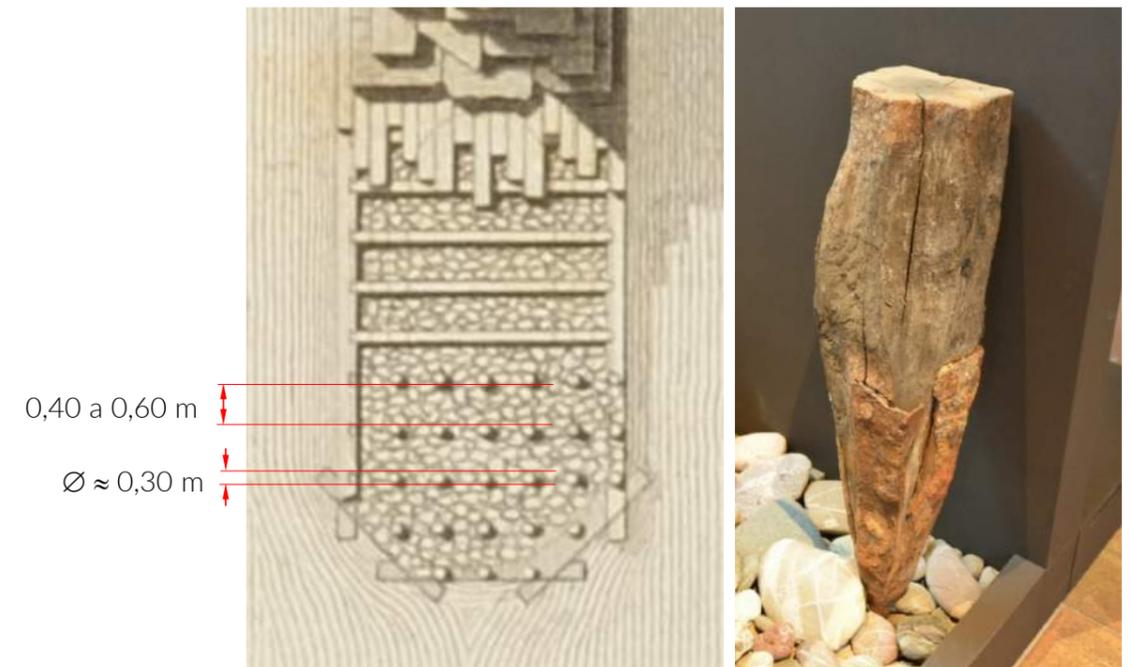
A la izquierda, esquema típico de las cimentaciones con pilotes y encepado de madera (tomado de Wiebeking y Perronet). A la derecha, extremo inferior de pilote con azuche (Museum für Geschichte, Basilea, Suiza)
